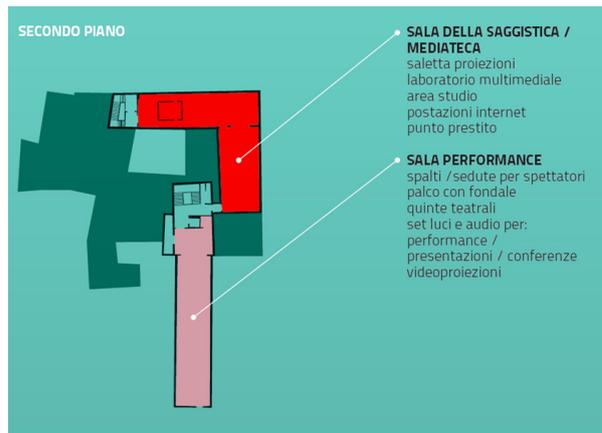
Planimetria Biblioteca della Ginestra (Secondo piano)
